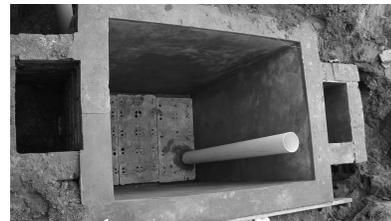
Instalación del falso fondo y tubo para extracción de lodos
